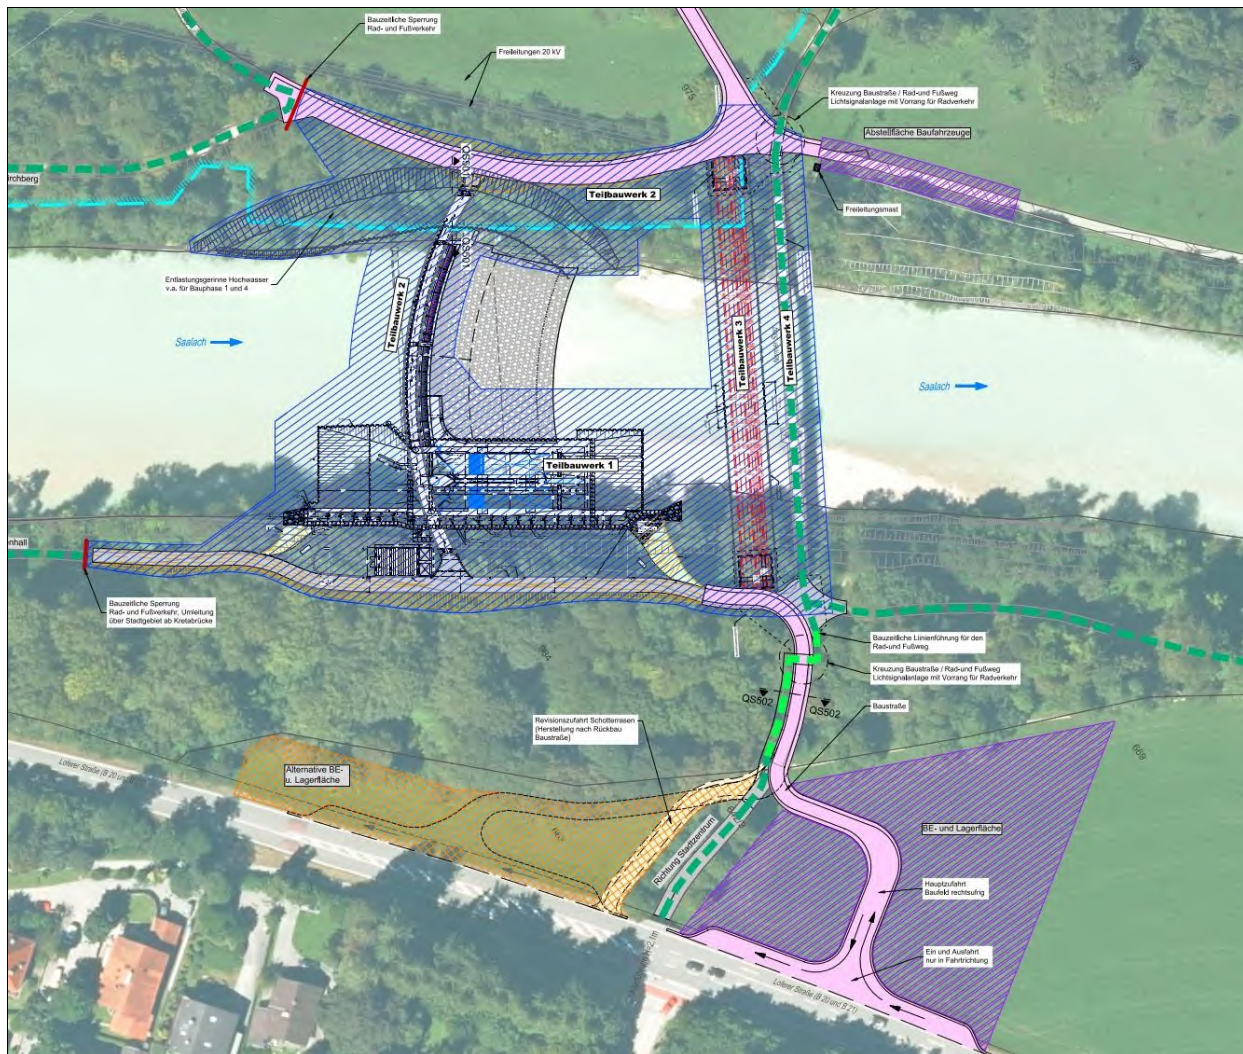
Lageplan Erschließung und BE-Flächen geplante Maßnahme (Quelle: IB Fichtner 2024b, Plan 500_BE_LP)
